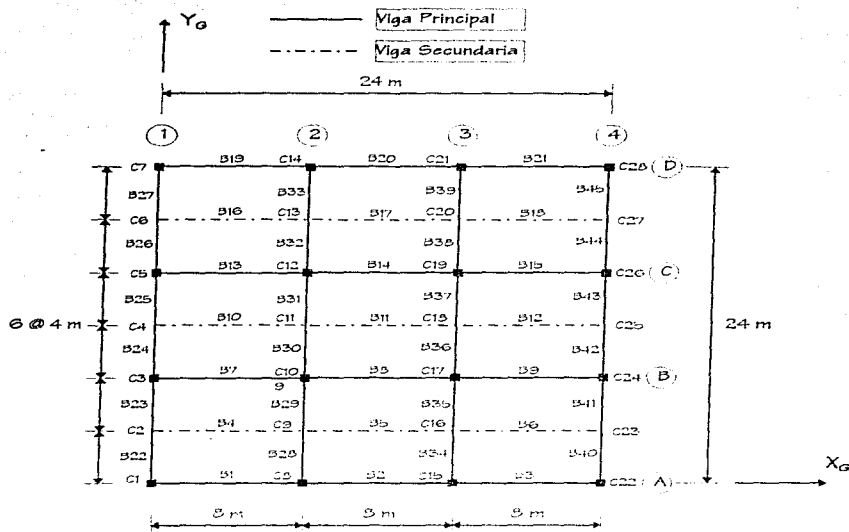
Planta tipo de la estructura de 17 niveles (ubicación de vigas y columnas)
